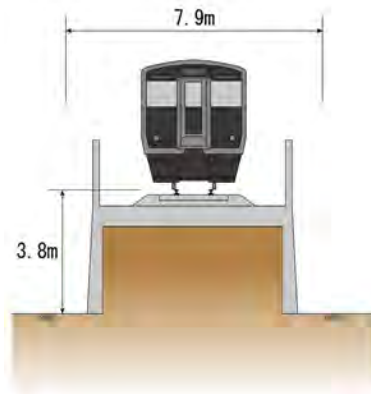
(1) 計画路線の標準横断面図 (断面①：地表式)
